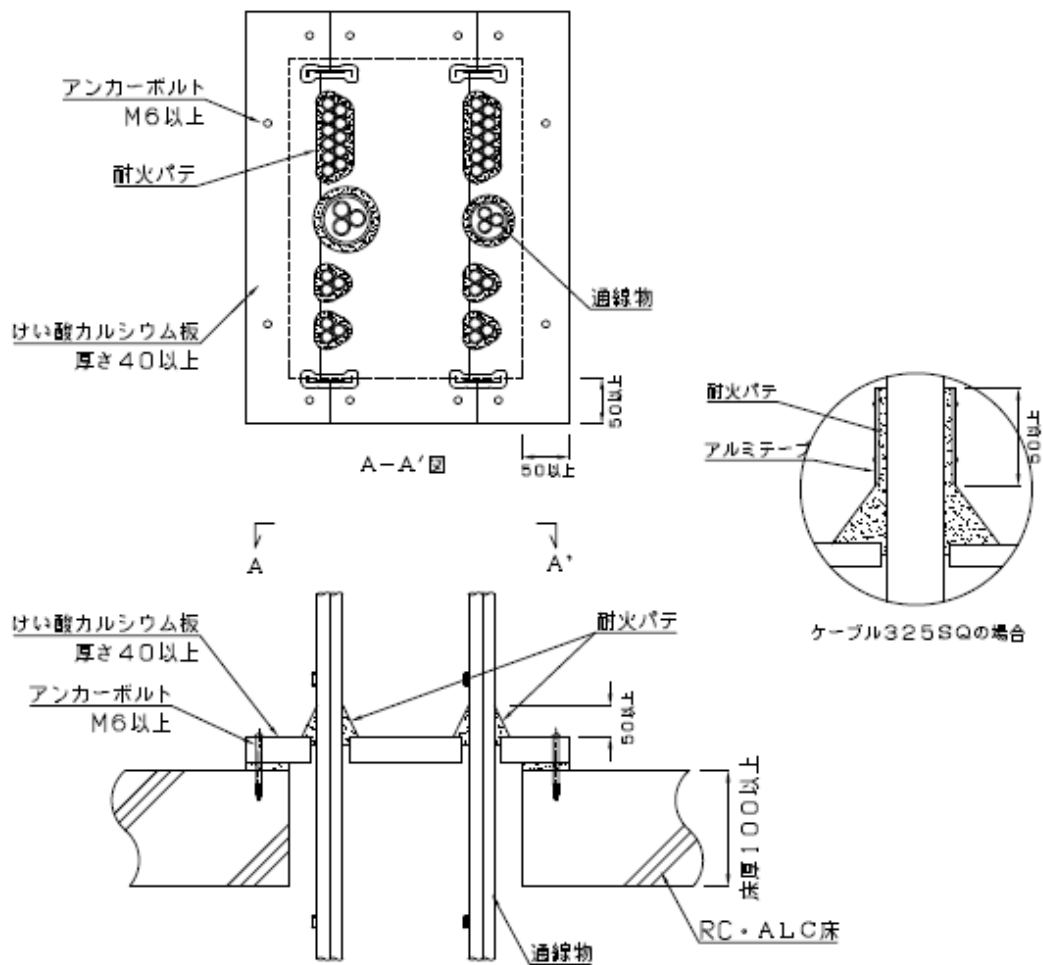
鉄筋コンクリート床(鋼製スリーブなし)貫通部の標準施工図
